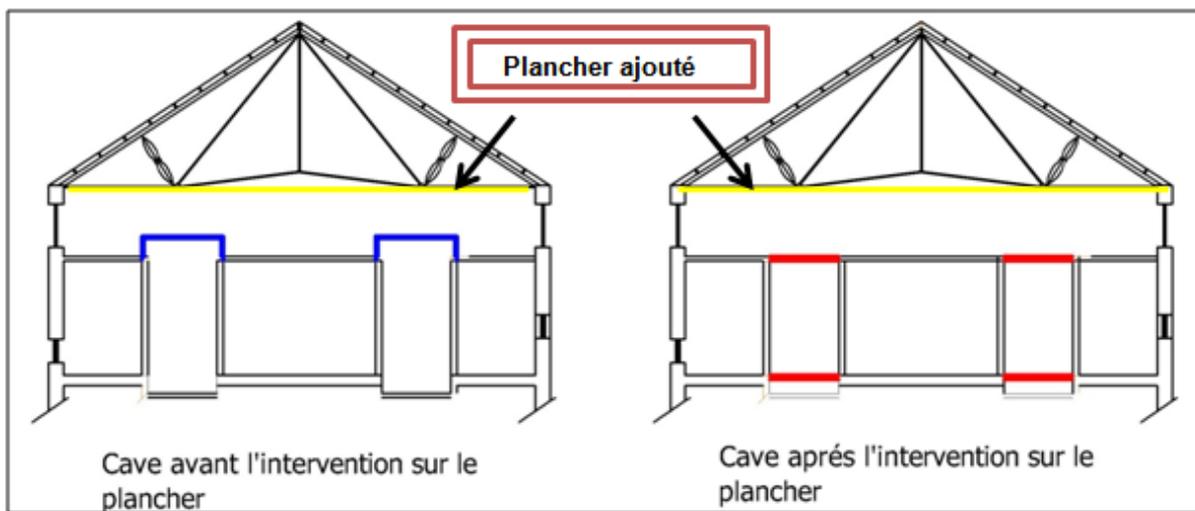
Coupe schématique démontrant les niveaux avant et après l'intervention sur le plancher
